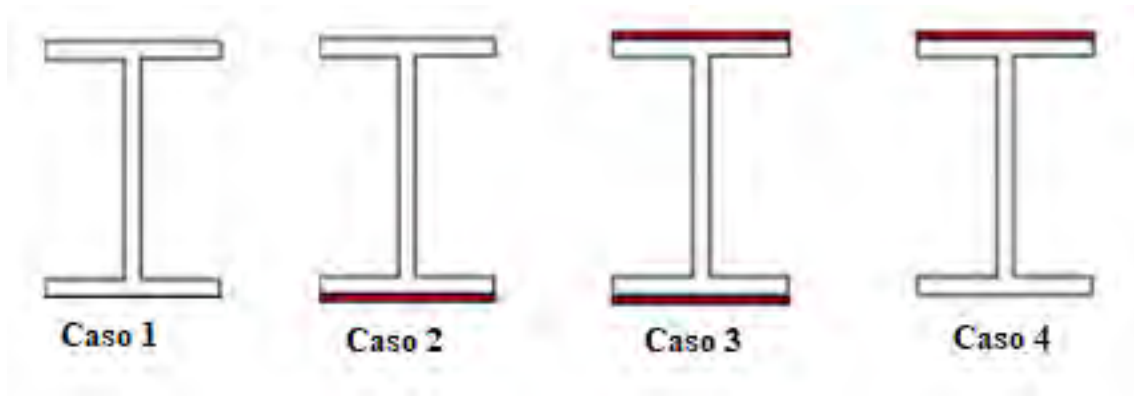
Configuración del reforzamiento de viga I con CFRP. Tomado de: (Shekarchi and Khaloo 2021)
